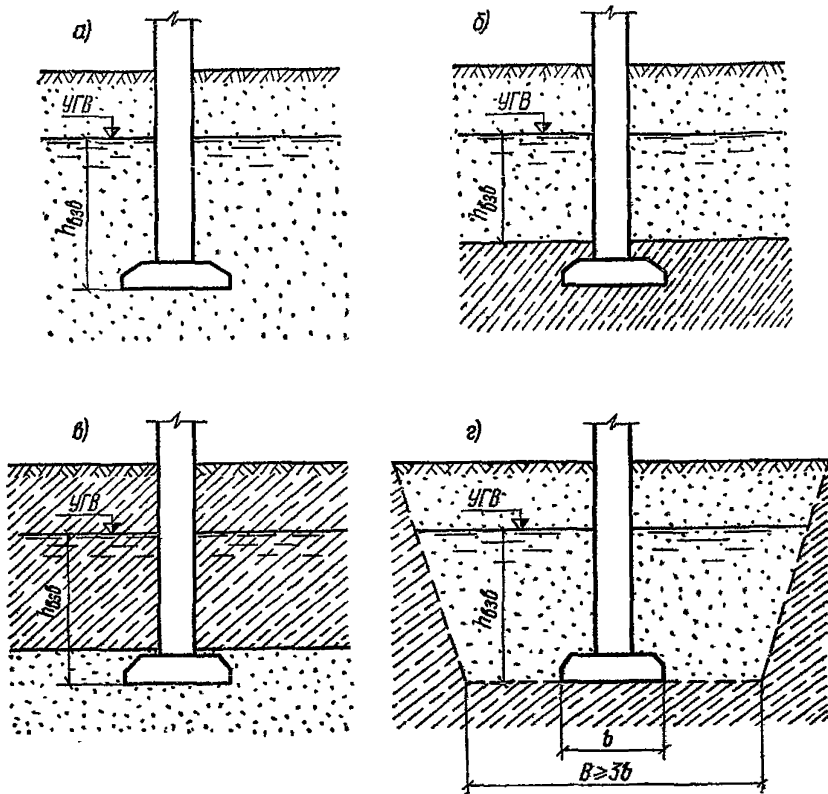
Схемы слоев грунта толщиной $h_{взв}$, для которых учитывается взвешивающее действие воды
